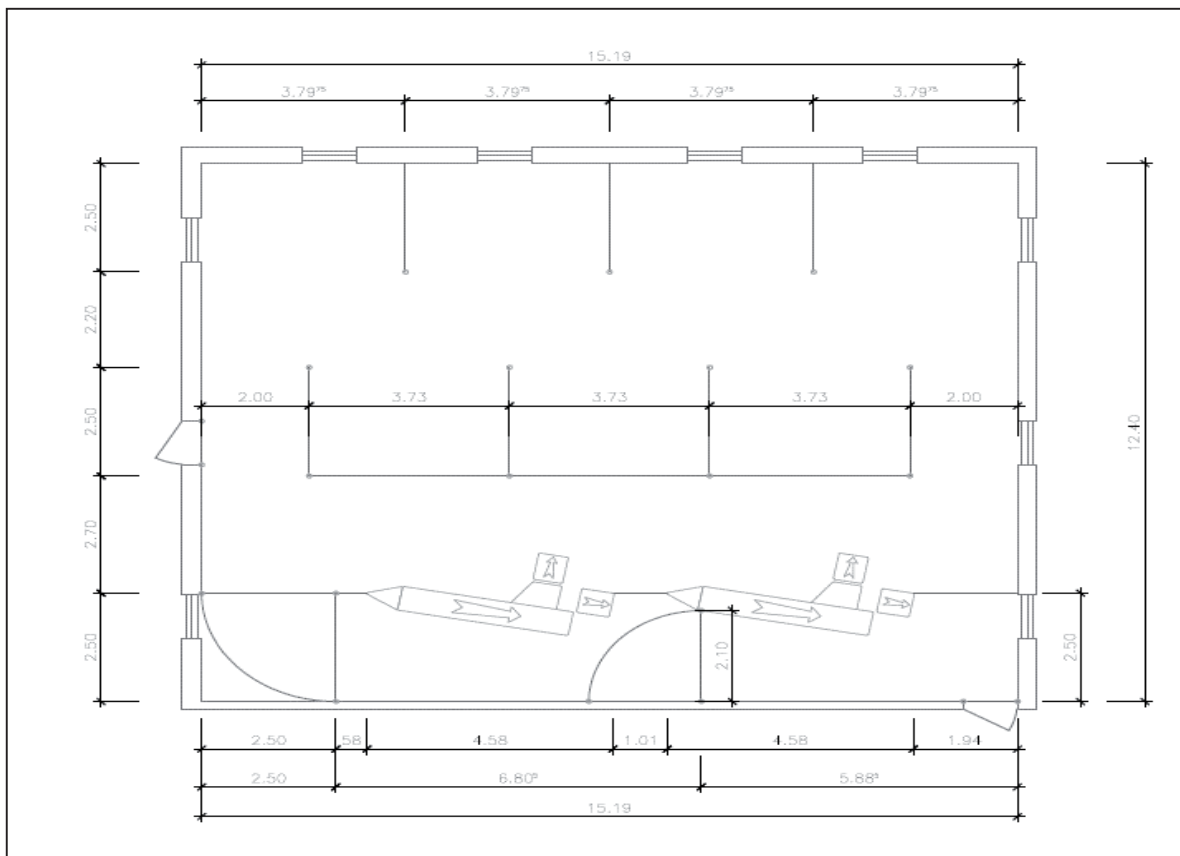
Grundriss des Wartestalles mit Abrufstationen CallMatic auf Betrieb B
